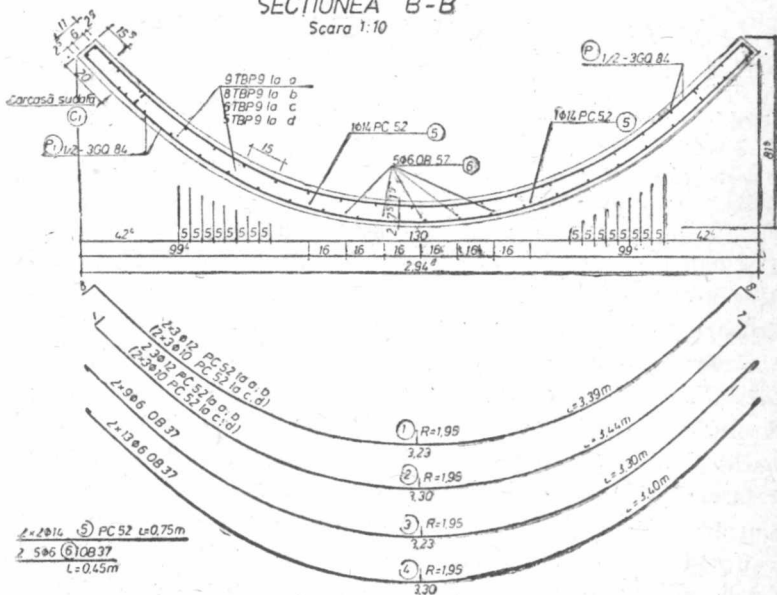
c. Armarea elementului UPH-15/3. Secțiuni transversale.
